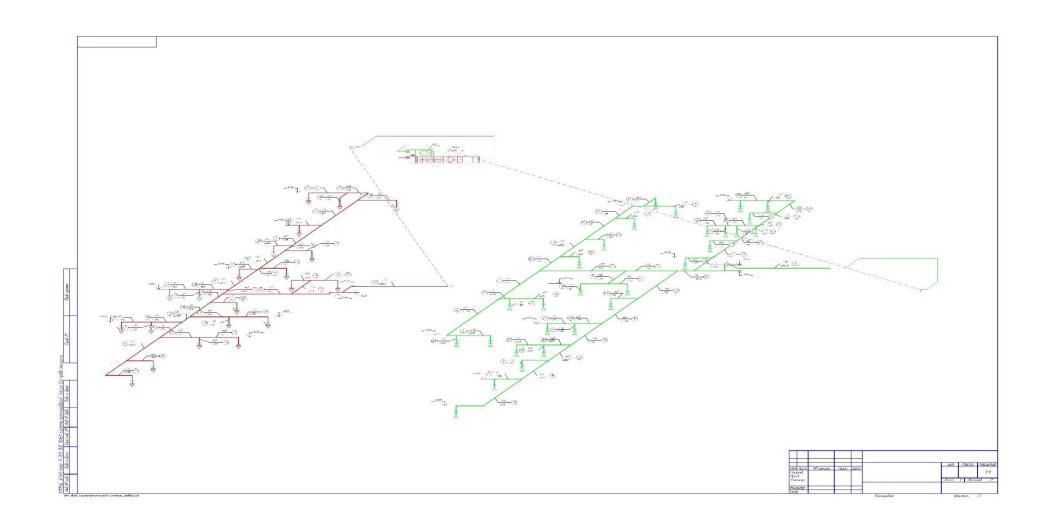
Расчетная схема системы вентиляции П2В2
